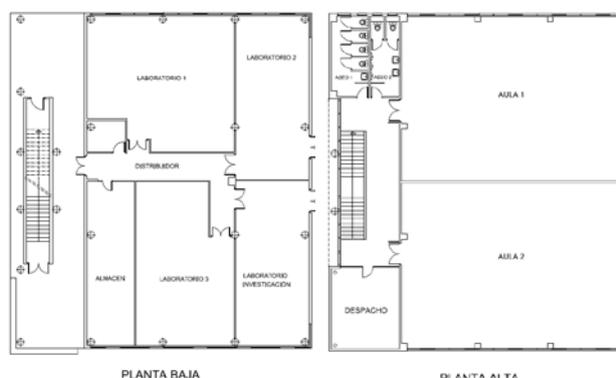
Planimetría de estado actual preliminar. (Imágenes obtenidas a partir de los planos facilitados por la escuela).
